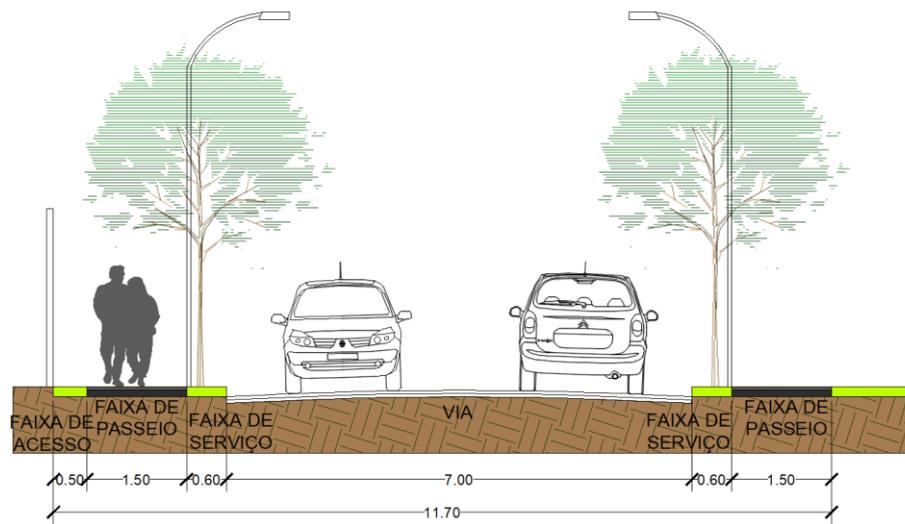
Perfil da Via de Circulação de Vizinhança 2 – Perfil 05 (Fonte: Própria)
